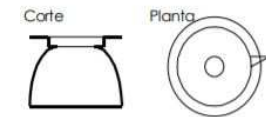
Planta y alzado de hábitat excavado en China, conocido como viviendas en saco. Neolítico.
